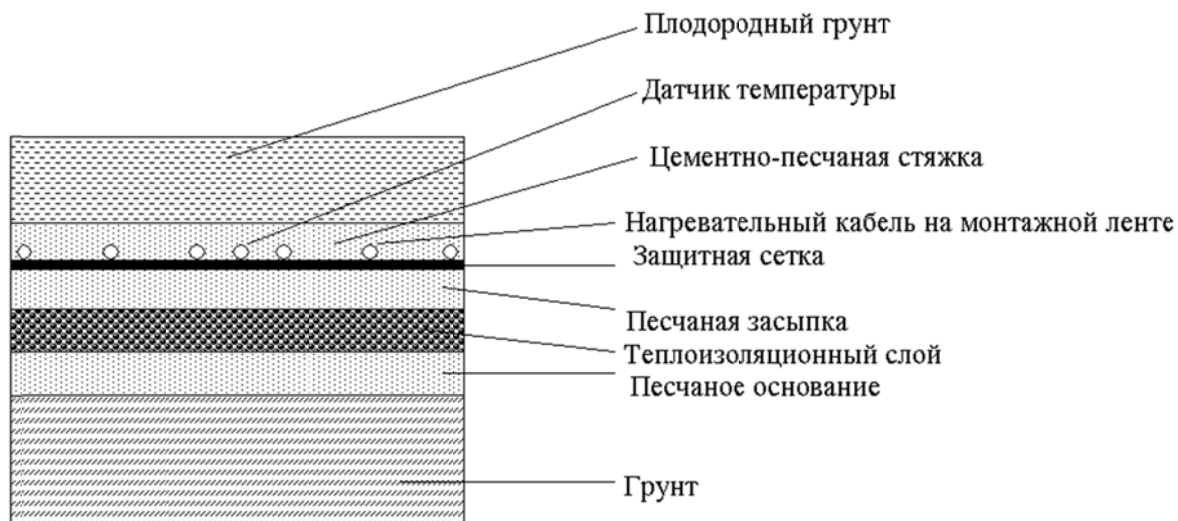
Схема укладки нагревательных секций в траншее при монтаже в бетонную стяжку
